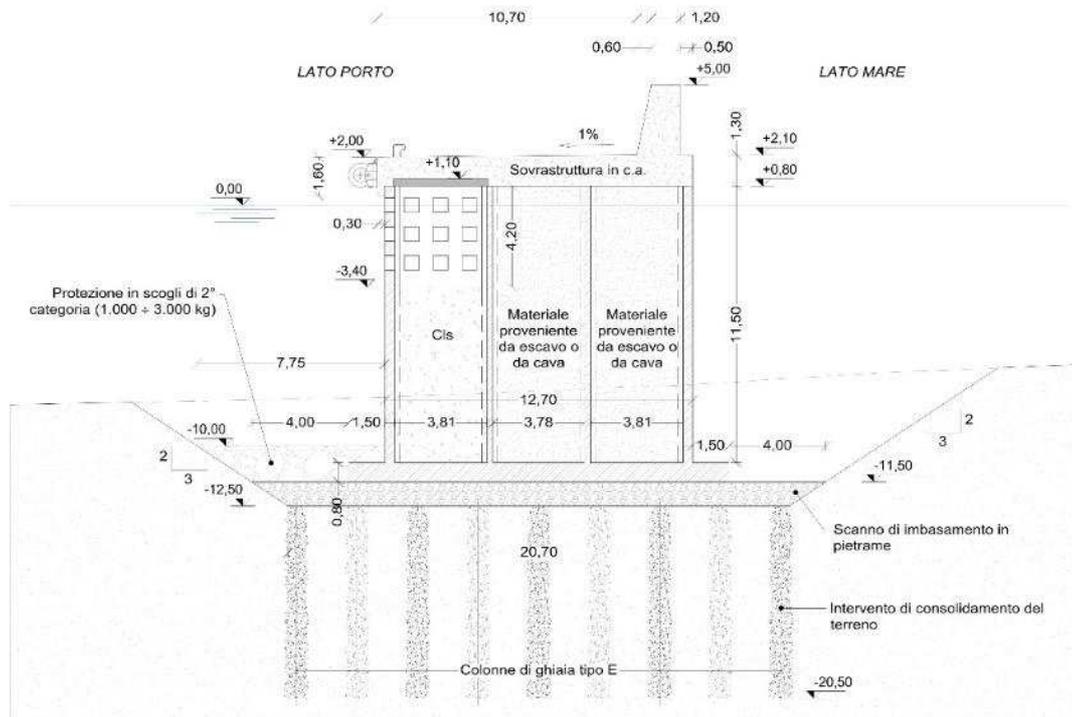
Cassone n°3 (diga a parete verticale): sezione tipo
